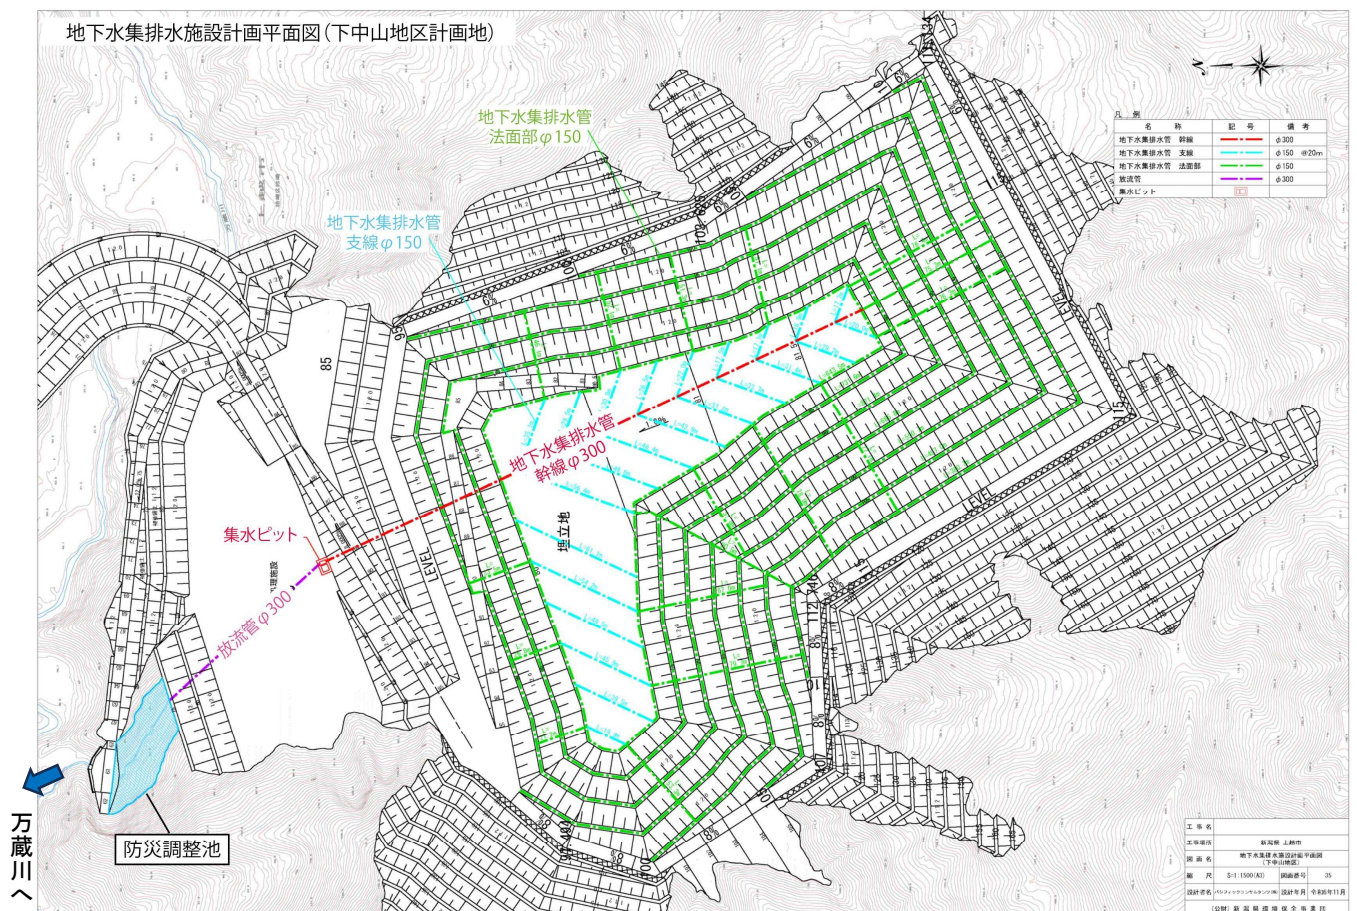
(2) 地下水集排水施設計画平面図 (下中山地区埋立地)
